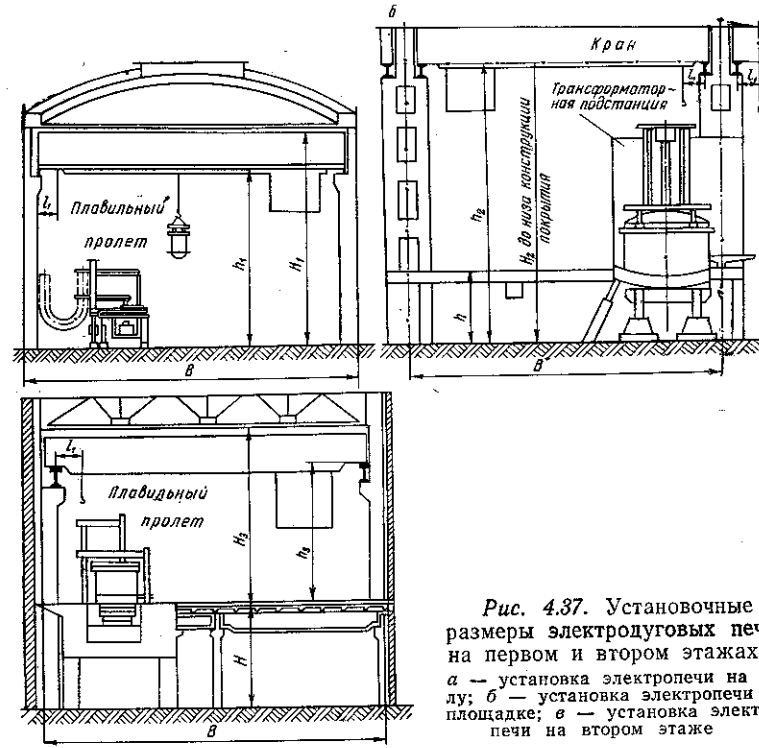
Установочные размеры электродуговых печей на первом и втором этажах: а — установка электропечи на полу; б — установка электропечи на площадке; в — установка электропечи на втором этаже
